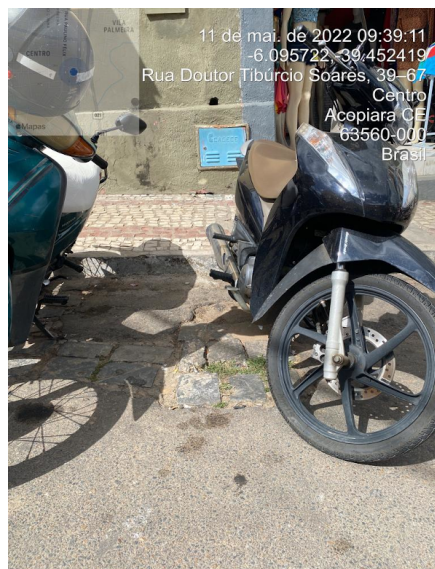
Rua Doutor Tibúrcio Soares, 39 - 67: pavimento sem recuperação.
